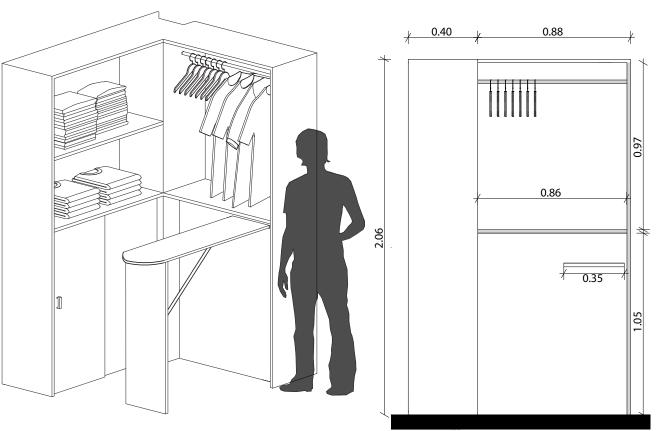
Perspectiva de mueble de planchado abierto Nota: Elaborado por el autor
